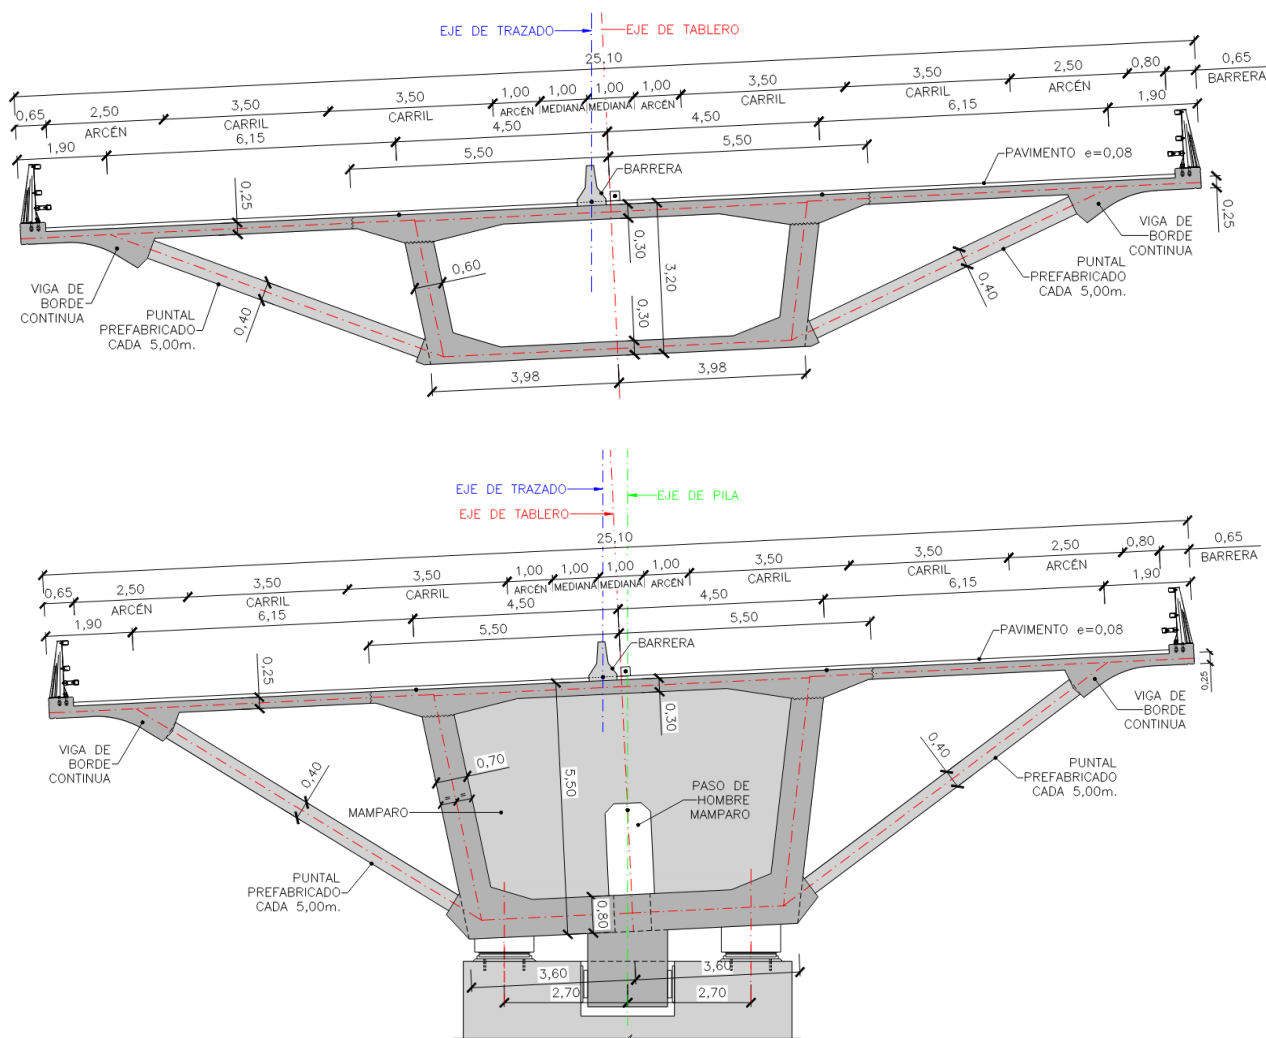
Arriba: Sección transversal por centro de vano. Abajo: Sección transversal por pila
